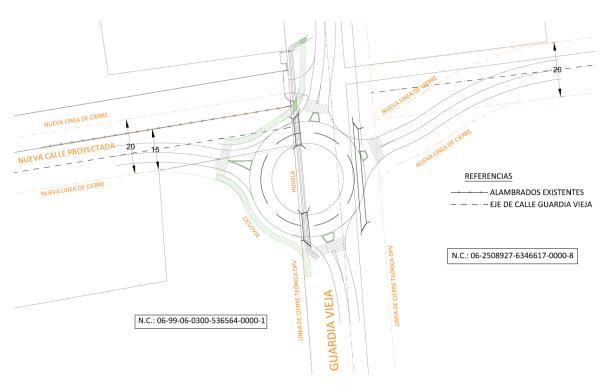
Proyecto Rotonda Calle Guardia Vieja y Calle Nueva Proyectada, Vistalba
